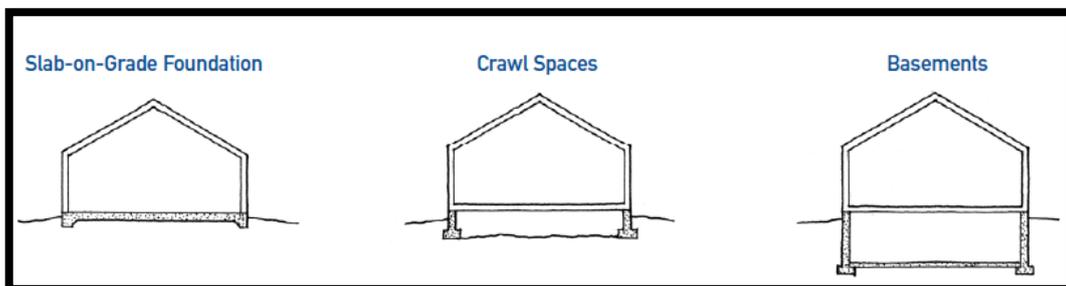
Tipo de Fudaciones. Fuente: Frame Construction.
